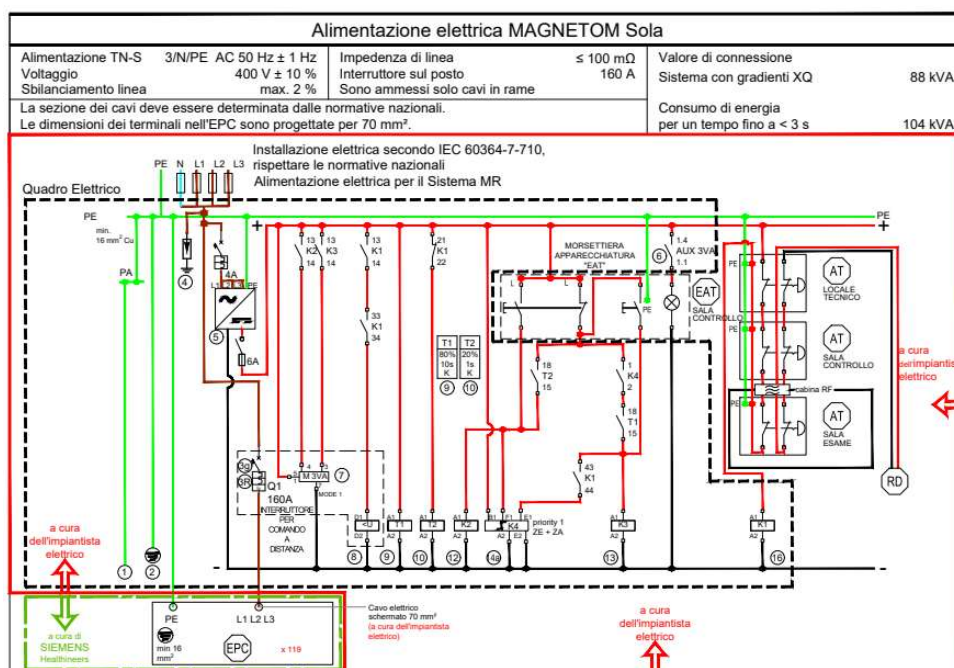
Stralcio Piano d'Installazione della Magneto Sola
